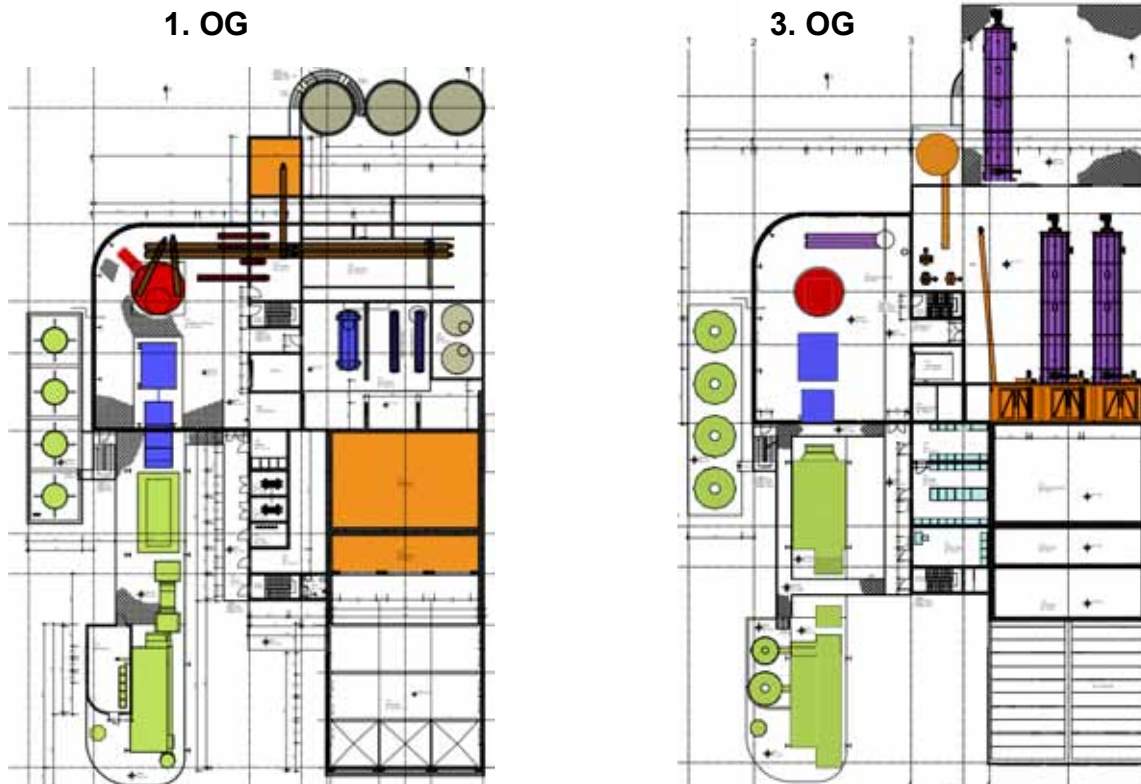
Grundriss 1. OG und 3. OG
